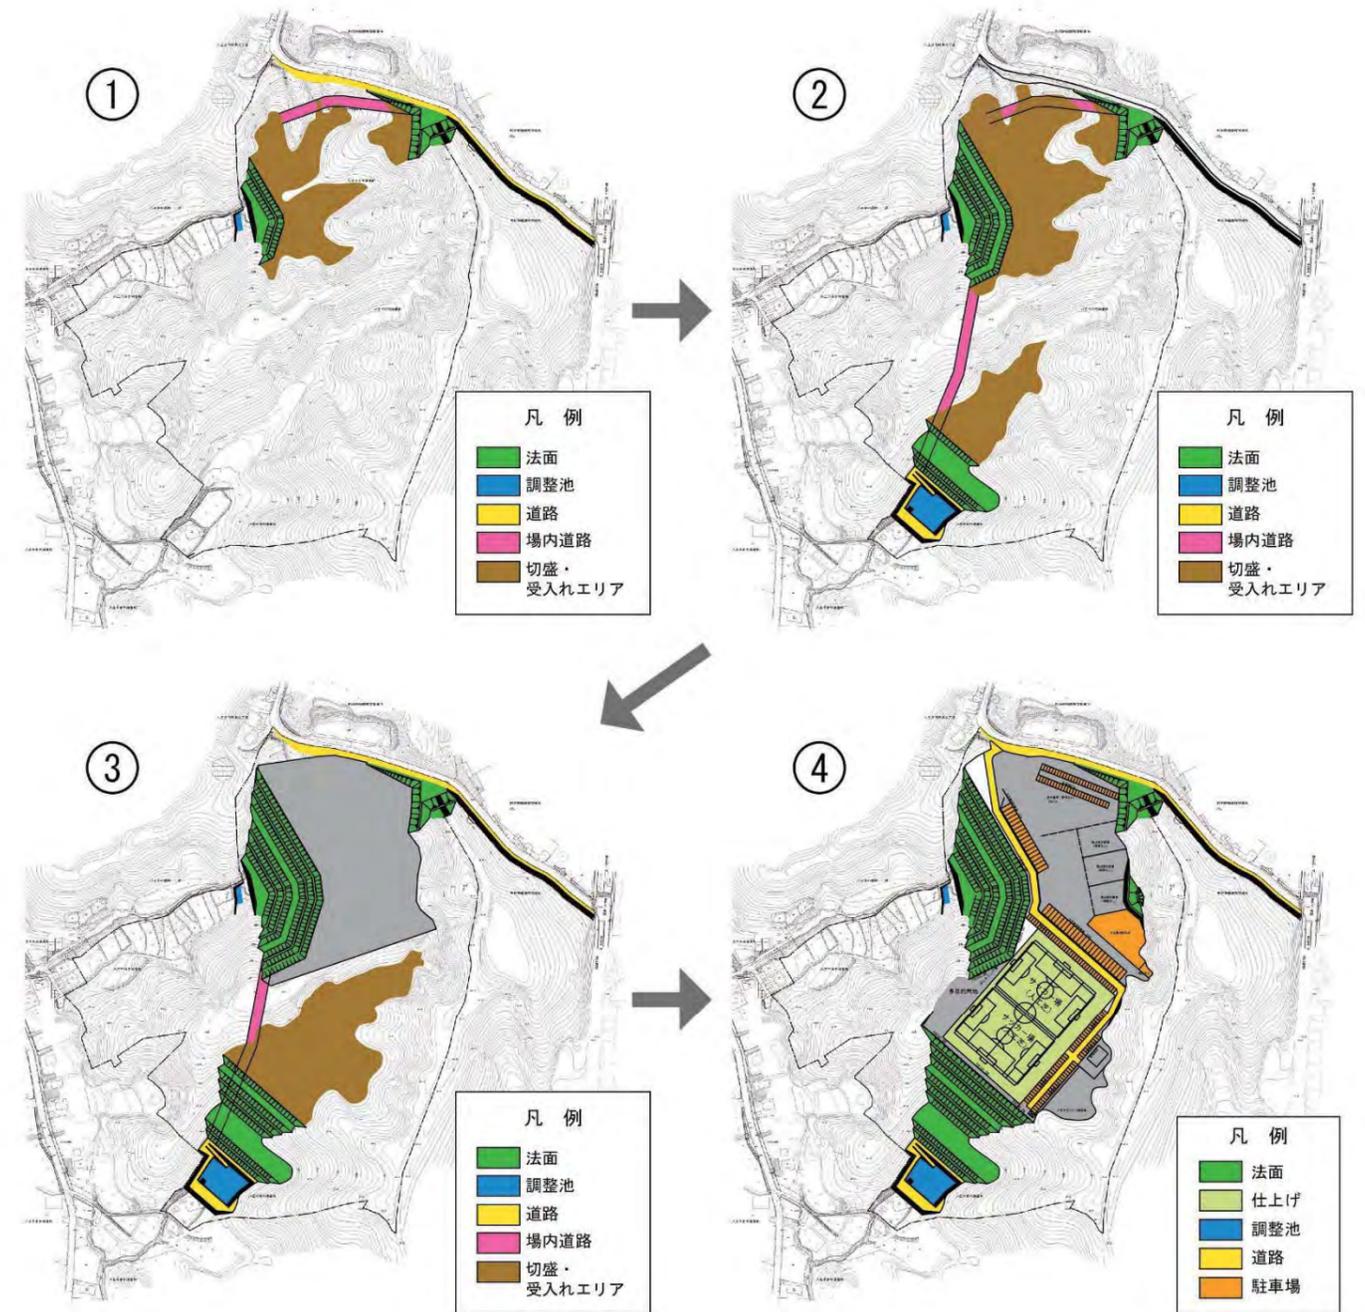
段階施工による退避路の確保・施工ステップ図
